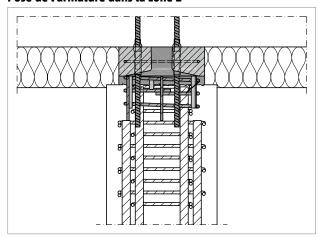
Schöck Sconnex® type P : pose de l'armature dans la zone 2 – coupe longitudinale du poteau
